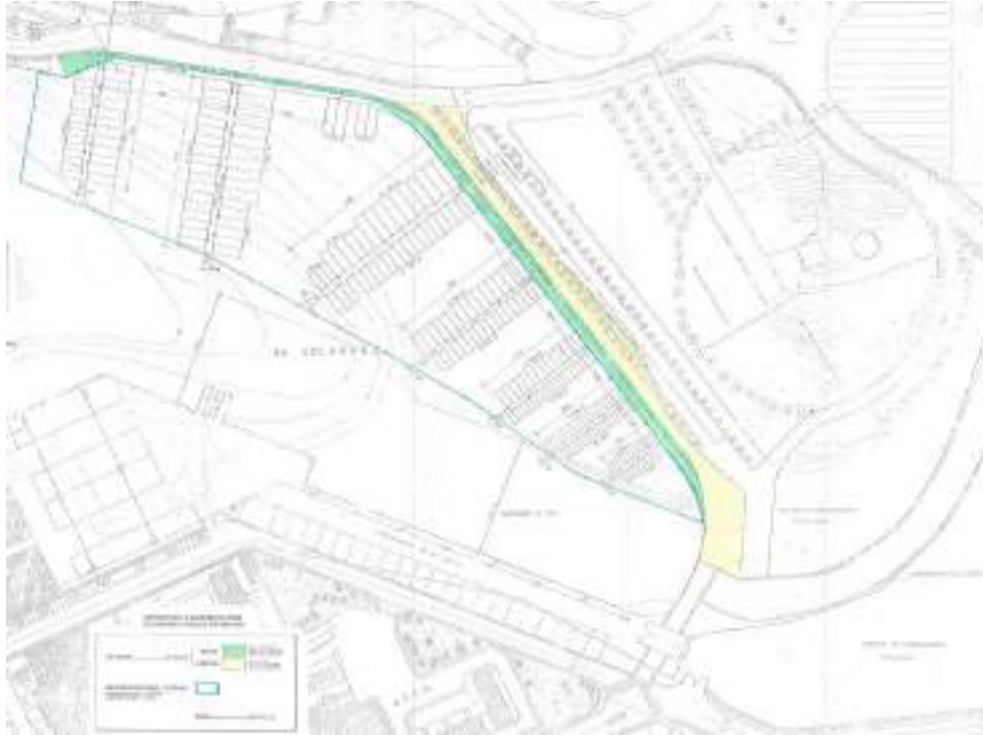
Plano de reconocimiento de las obras facilitado por la APB.
